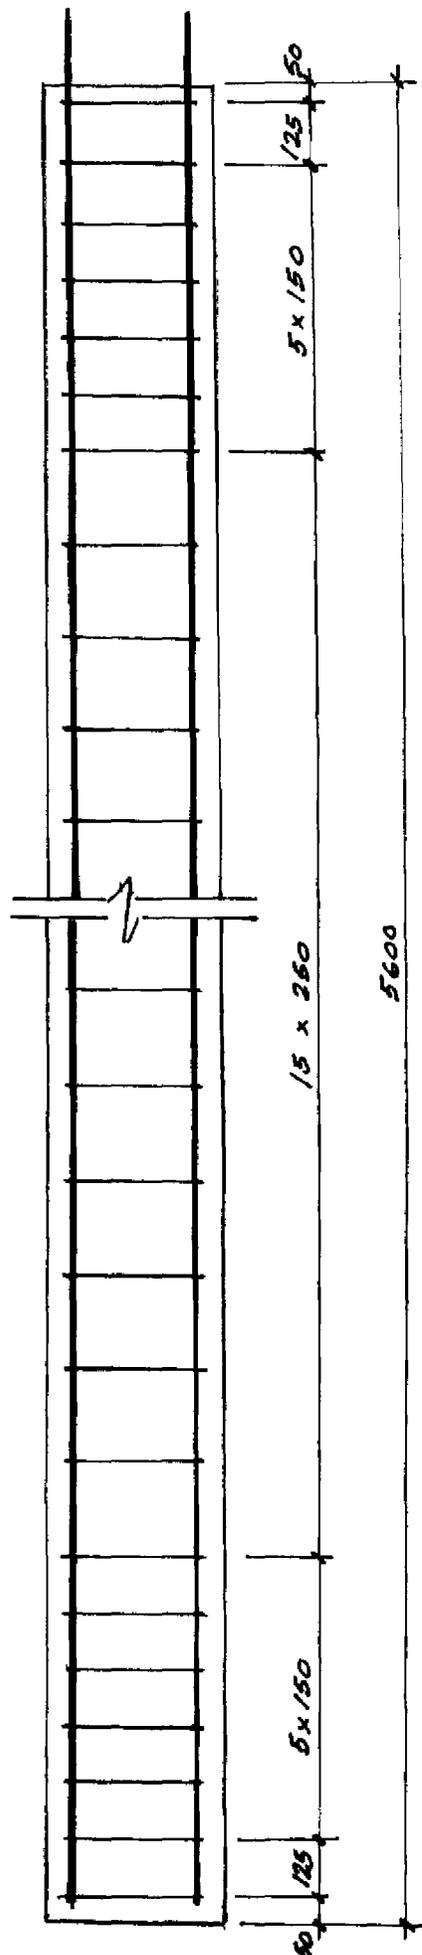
DETALLADO DE LOS ACEROS RECOMENDADOS PARA LAS COLUMNAS DEL SISTEMA
